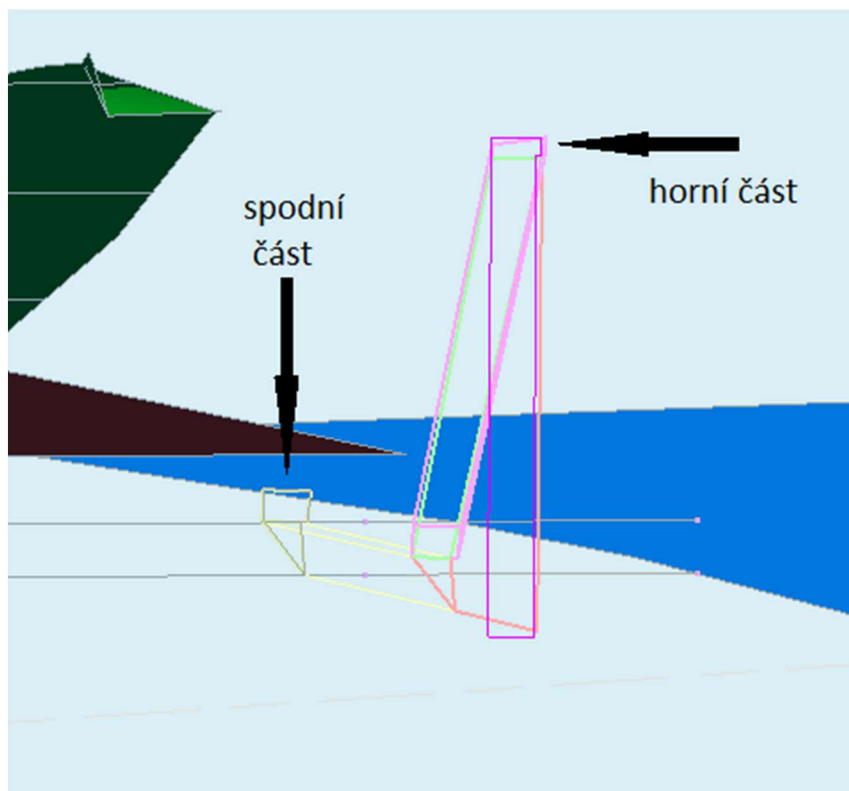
Betonová patka sloupu trakčního vedení v softwaru Revit 2020
